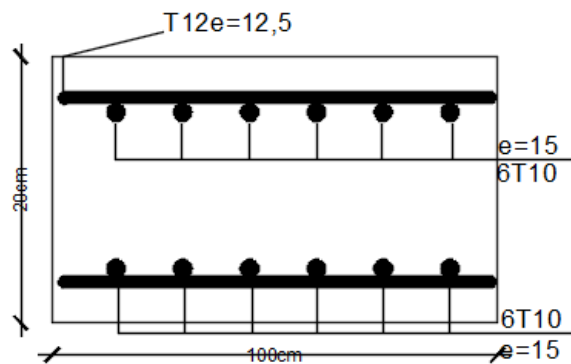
Ferrailage de la dalle pleine rectangulaire.
